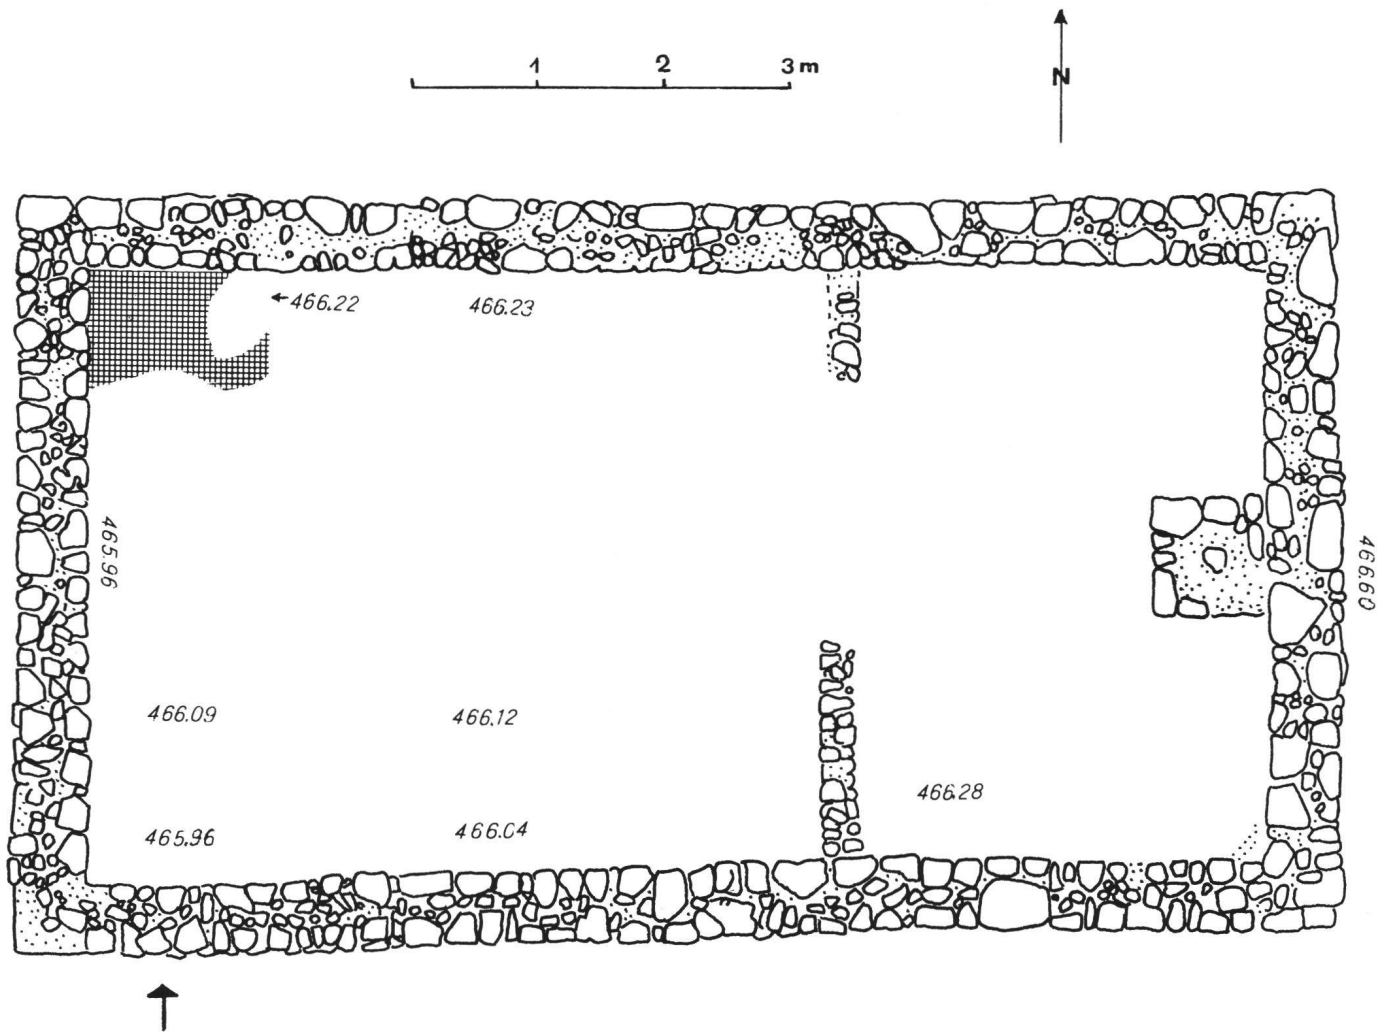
Grundriss der streng nach Osten gerichteten Kapelle mit dem Eingang (Pfeil) im Westen, Chor und Altar im Osten. In der Nordwestecke der glatte Fussboden mit Zielschlag.
